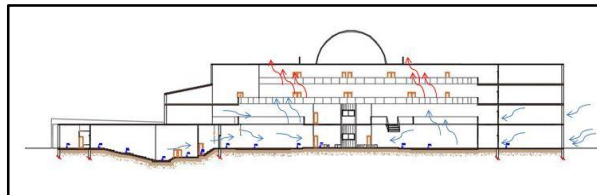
Coupe au niveau de l'espace central détermine le mécanisme du ventilation. Source : Auteur
